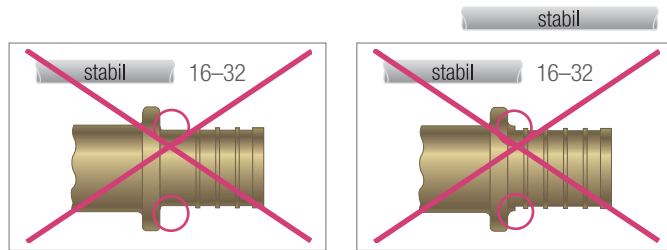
Fitting de latón sin topes anteriores con perfil, dimensiones 16-32
